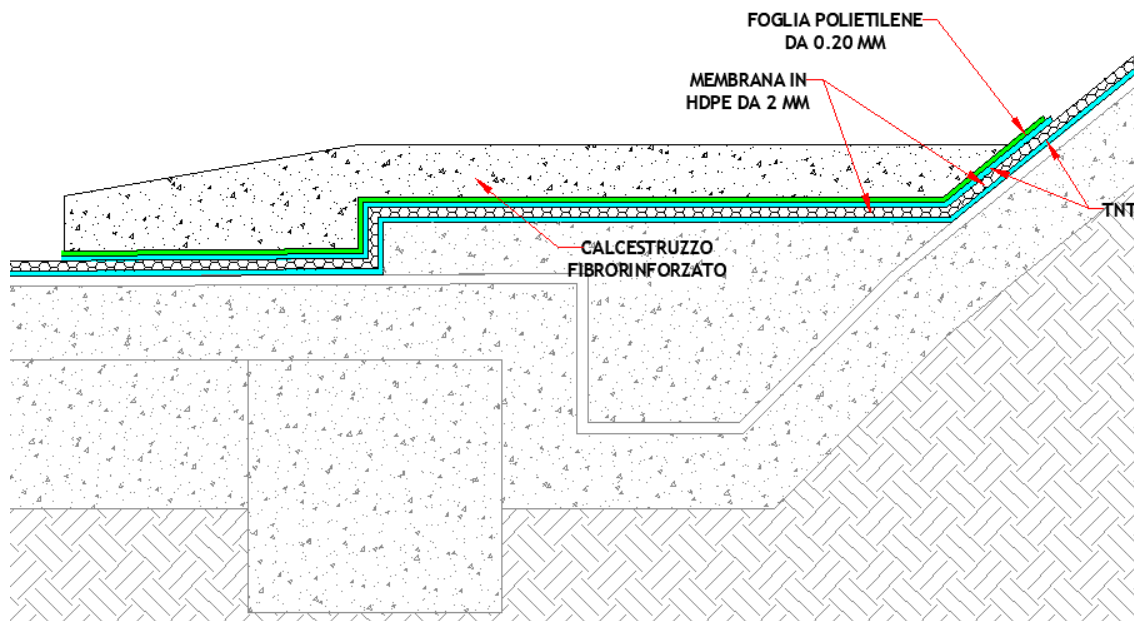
Particolare dell'elemento di protezione in cls sul fondo
